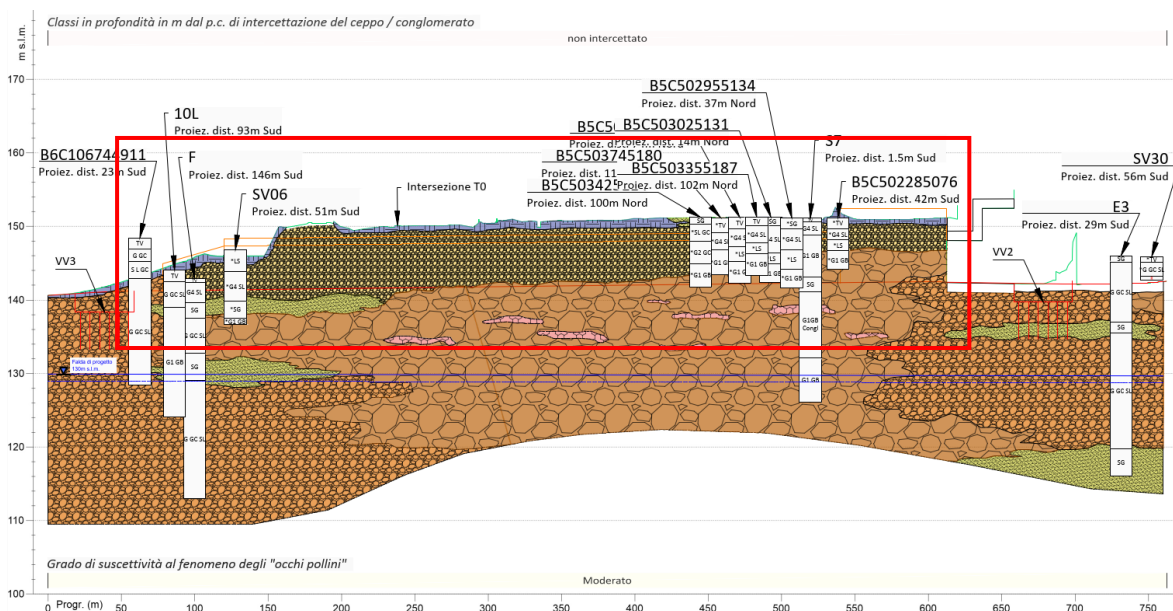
Estratto della sezione geotecnica LA (in rosso la zona interessata dall'intervento) (Rif. [4]).
